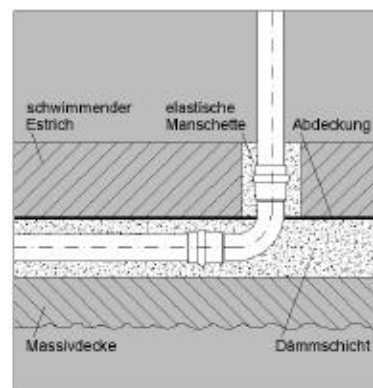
Rohrleitungen unter dem Estrich (in Wärme- und Trittschalldämmung)
